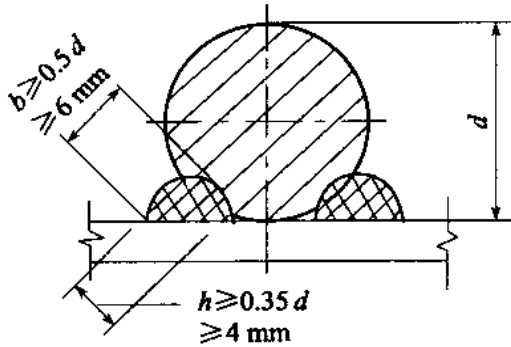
2 钢筋与钢板焊接的焊缝
